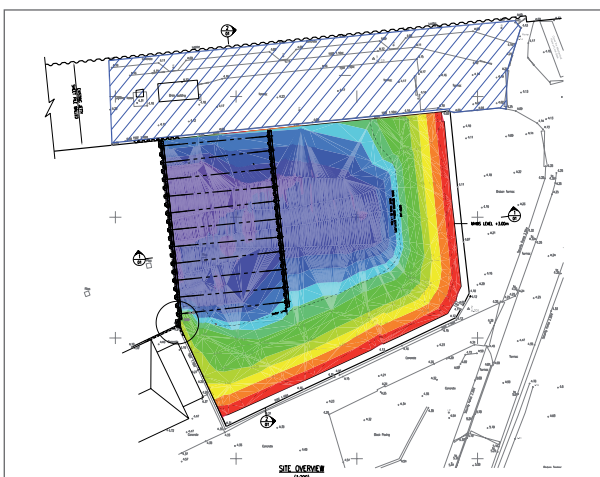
Hafen Shoreham, Lageplan der Uferwand.
